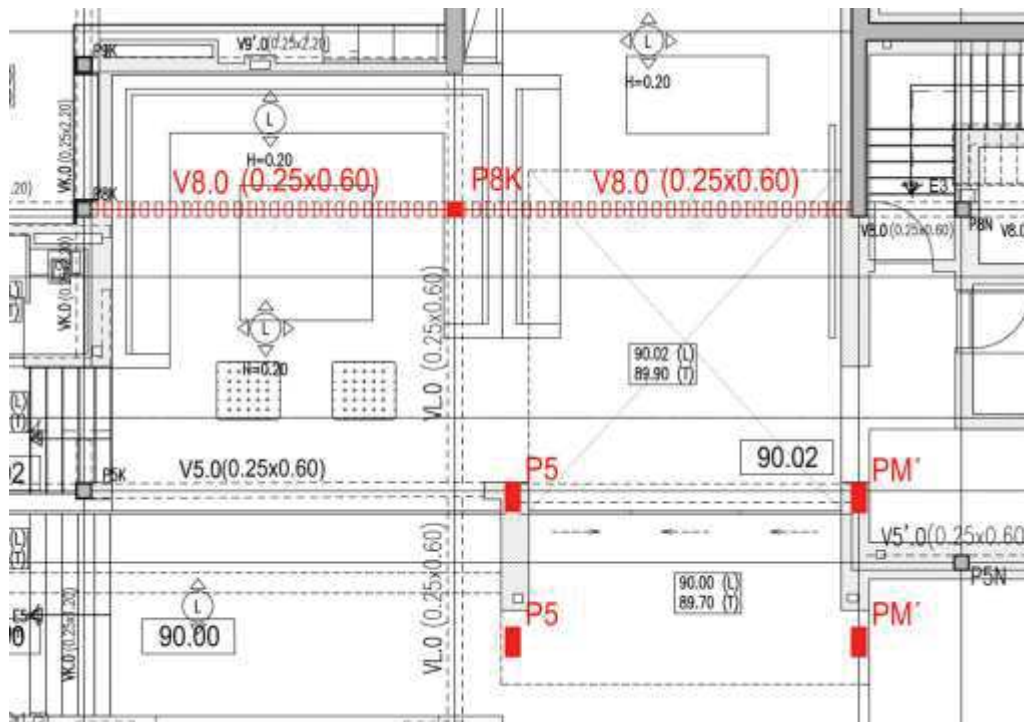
Verificação dos Pilares 5 e PM' e P8k e viga V8.0
